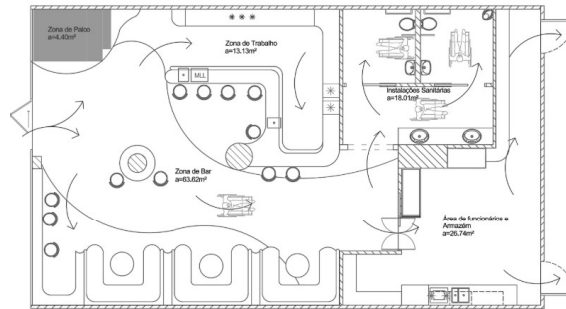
Identificação do Palco em planta (Camila Schmidt, 2025)
